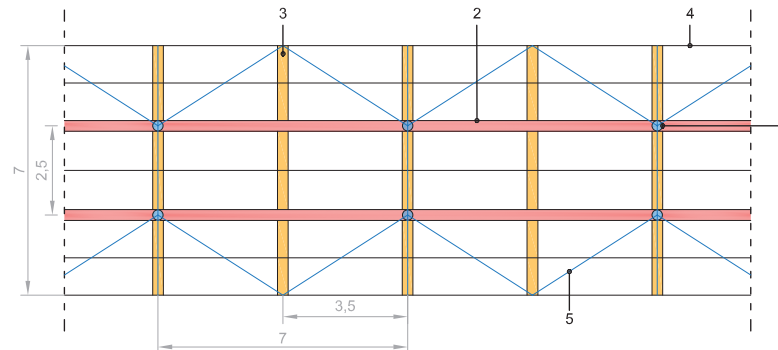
Esquema planta estructura marquesina estación de Sagunto
